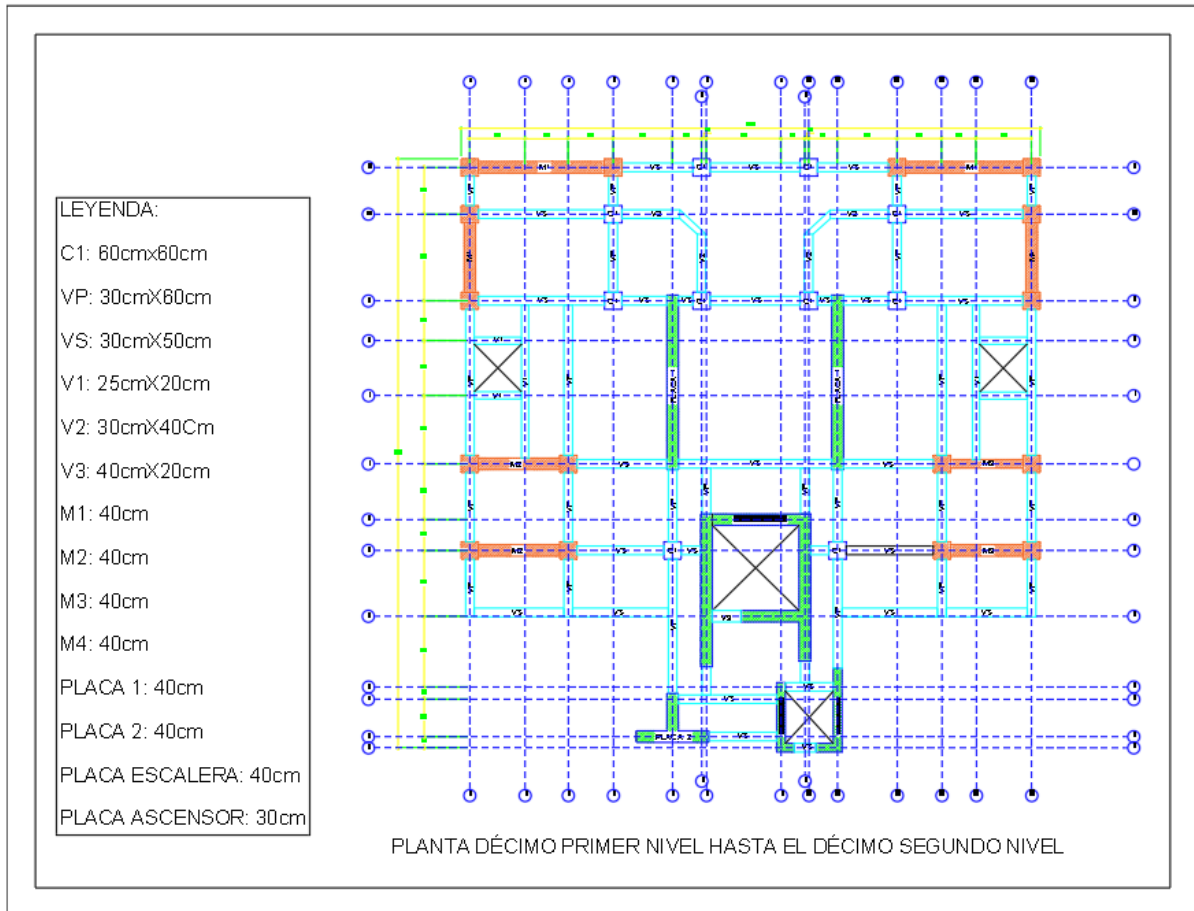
Plano de Estructuras Planta 10mo piso - 12vo piso.
